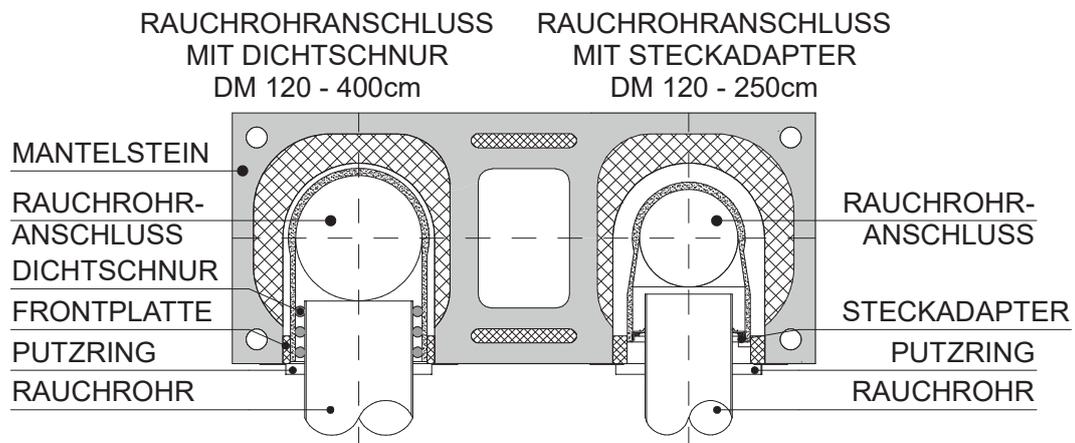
Rauchrohranschluss mit Dichtschnur und Steckadapter (Schiedl Kamin)
